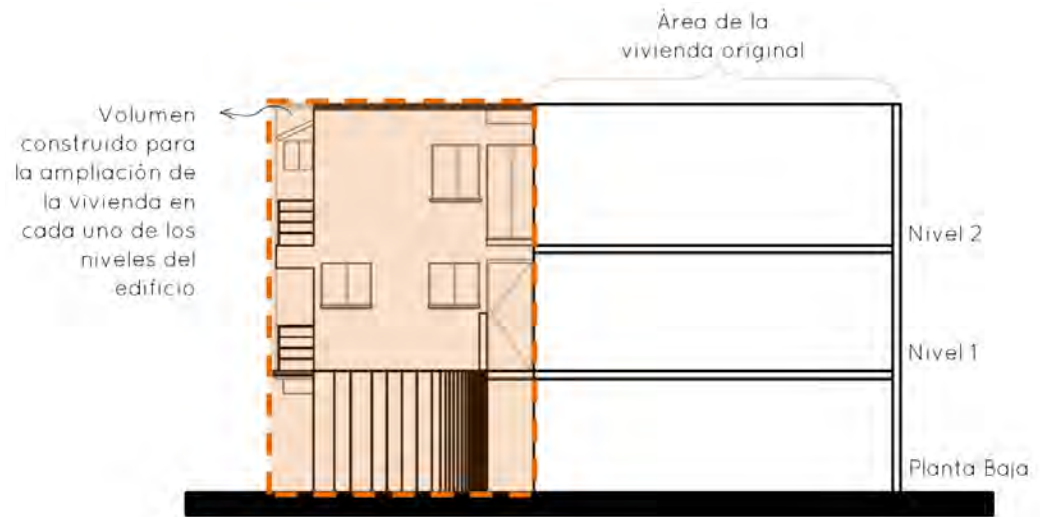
Alzado del edificio donde se indica con color rojo el volumen agregado. Fuente: Propia 2018
